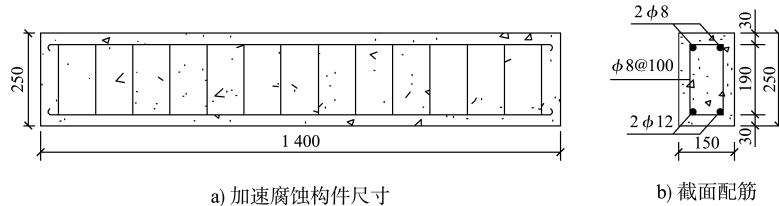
加速腐蚀构件尺寸及截面配筋 (单位: mm)
